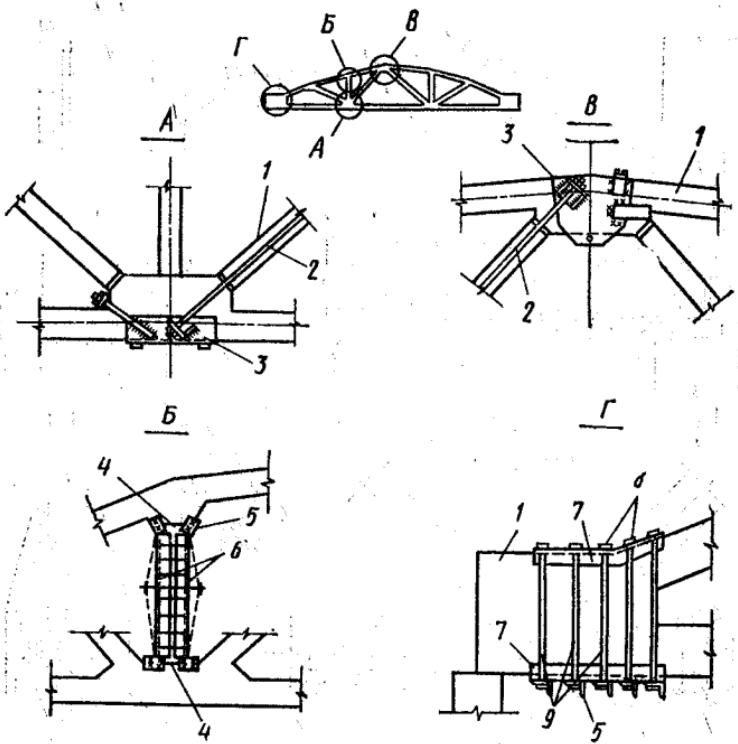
Усиление элементов решетки и узлов фермы:
